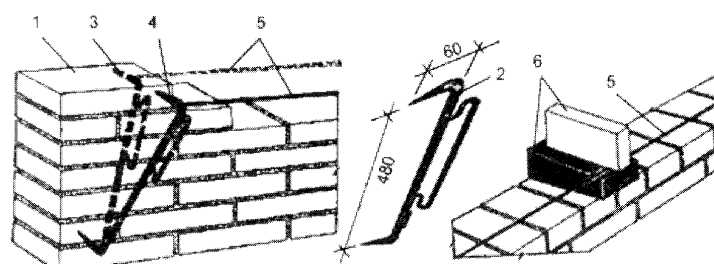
Схема начальной кладки. Вариант кладки стен в полтора кирпича
